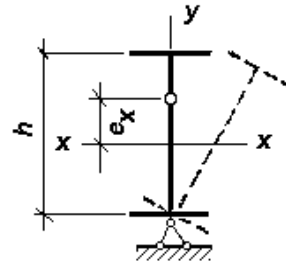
Схема перерізу елемента, підкріпленого вздовж полки
